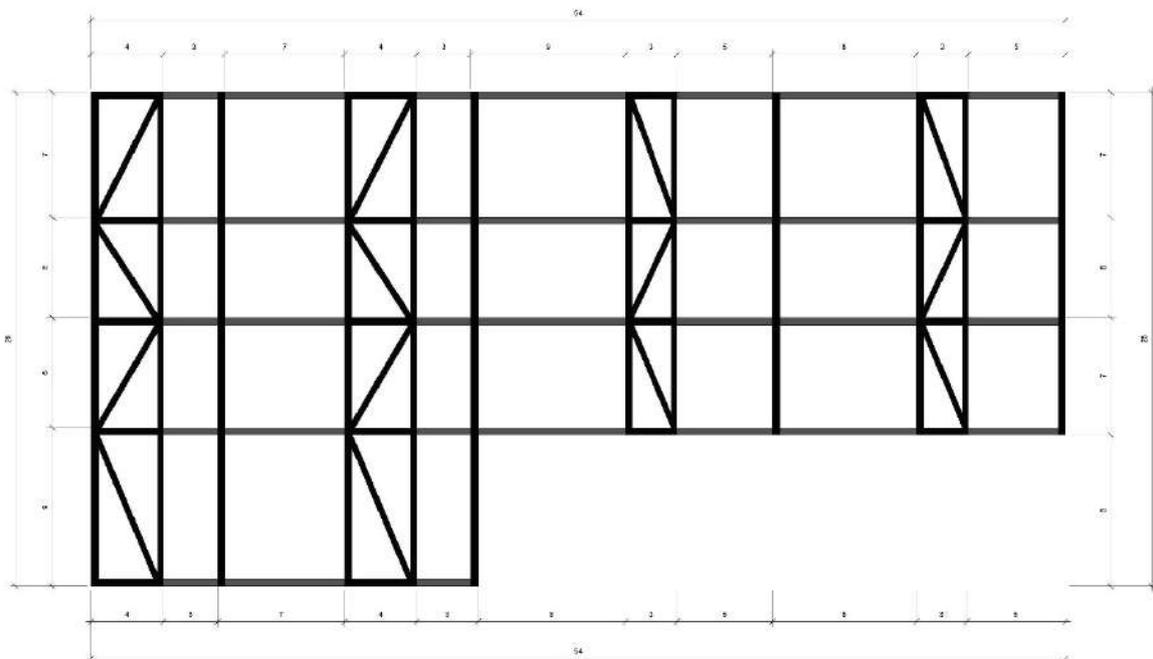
Estructura Planta Producción, talleres y laboratorios
